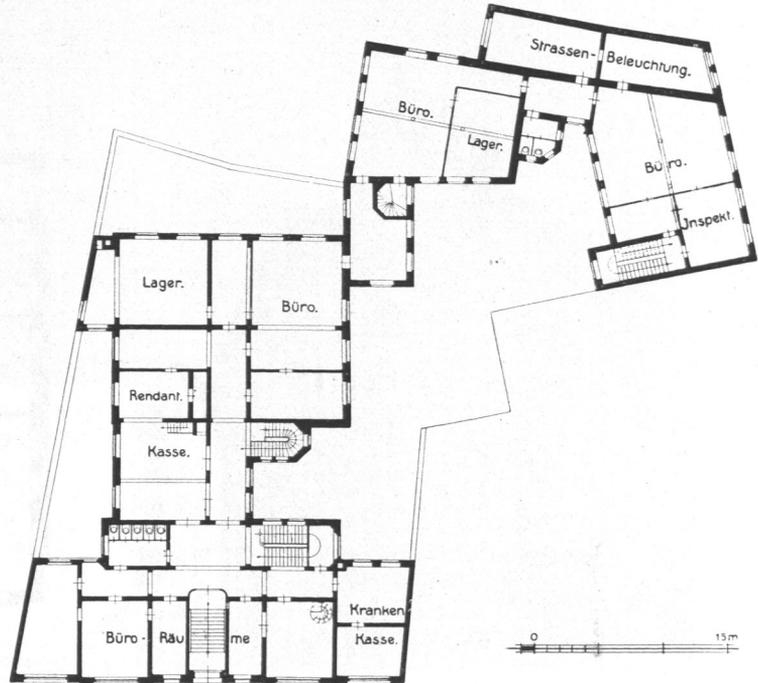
Dienstgebäude für das Beleuchtungswesen, Grundriß, Erdgeschoß.
